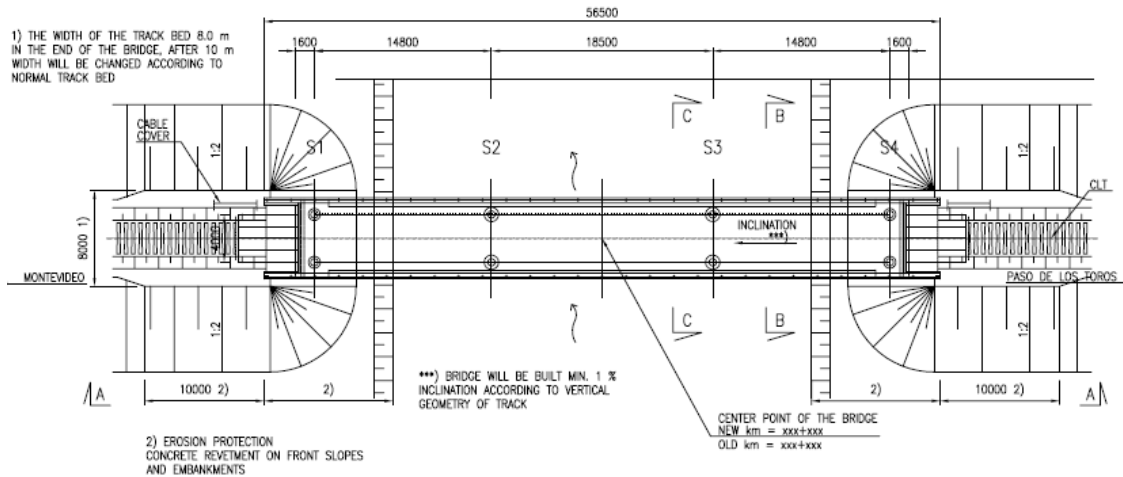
Planta de modificación proyectada para puente en cañada De Las Piedras (progresiva 082+426)
